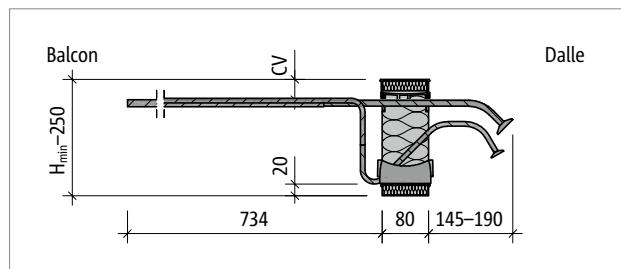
Schöck Isokorb® T type K-O-M2 : coupe du produit
